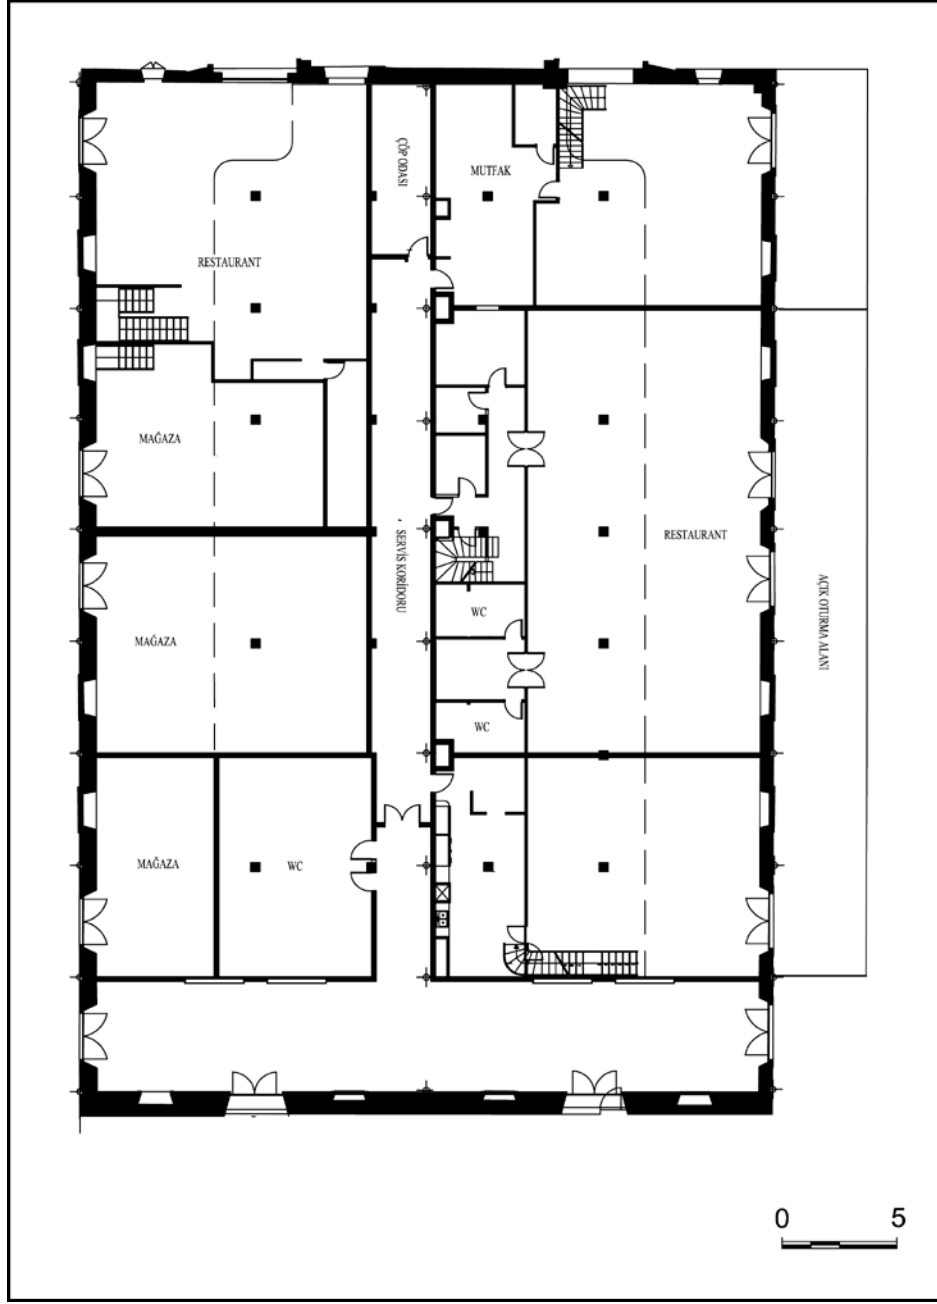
II. Dönem Hurda Ambarı 2 Binası Plan Şeması
